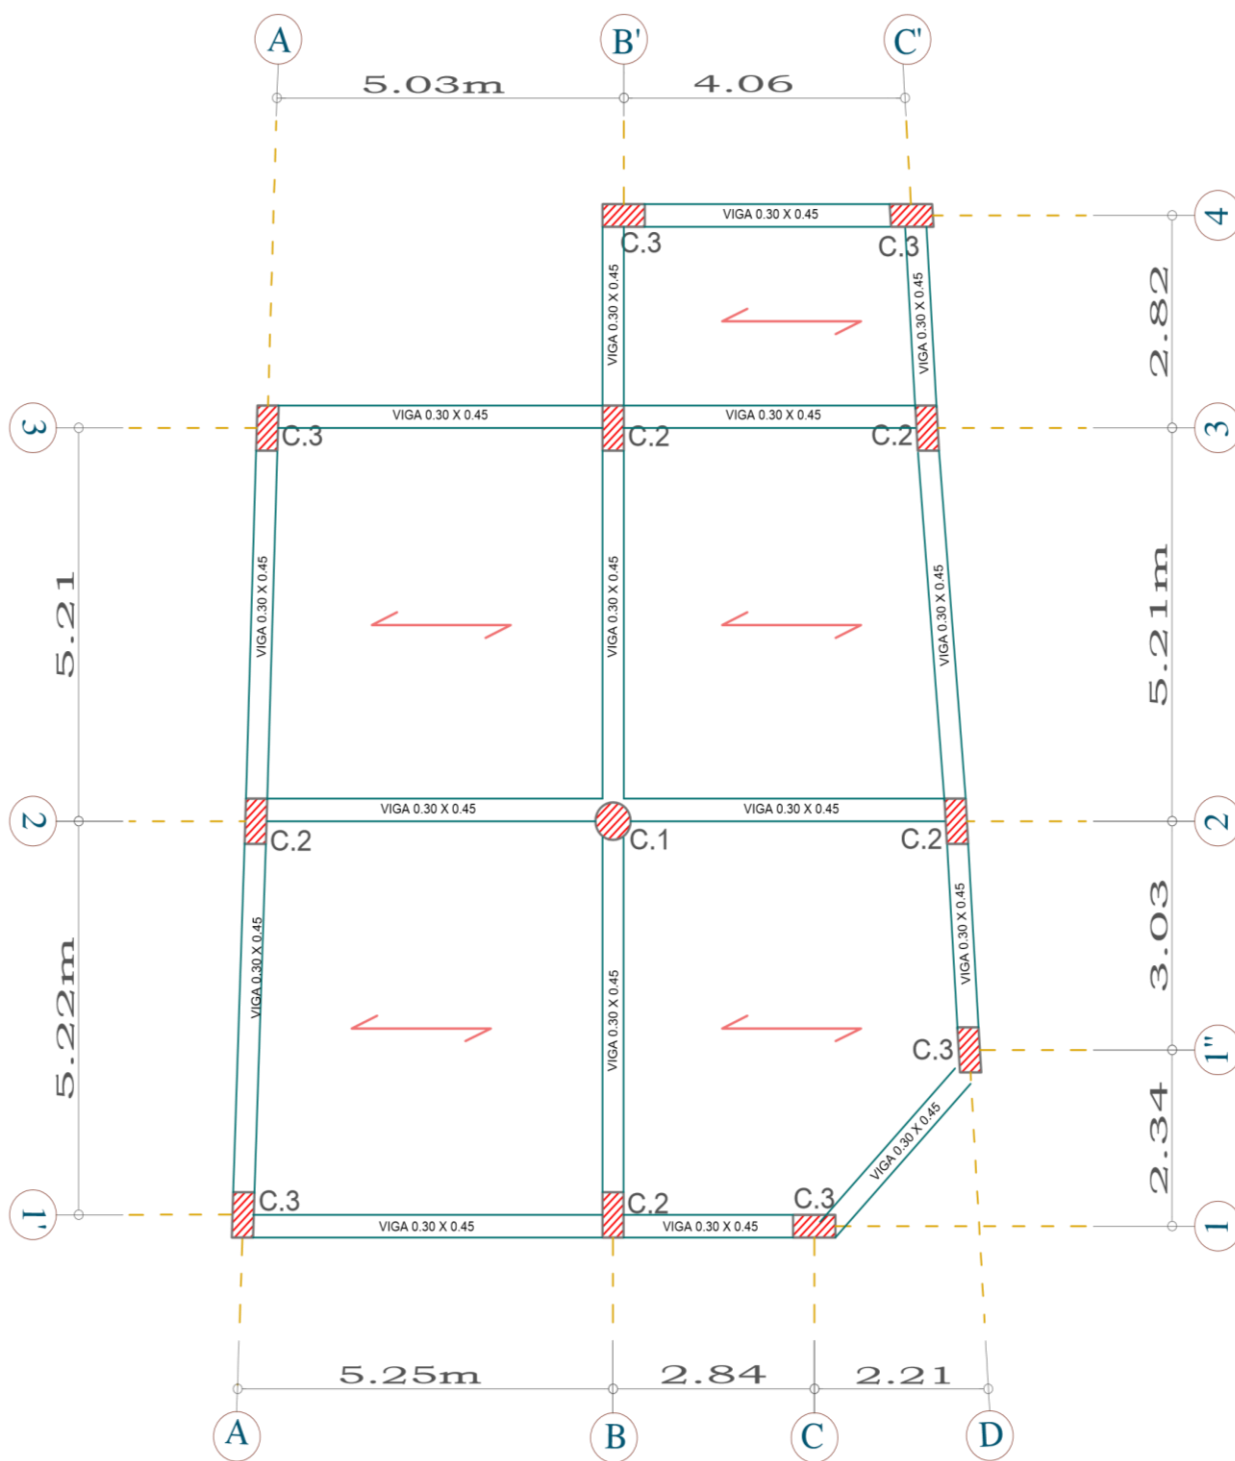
Plano de estructuras-Sistema aporticado, se muestra los elementos vigas y columnas del edificio multifamiliar
